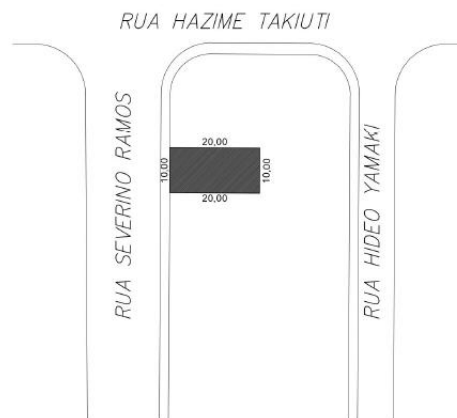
Localização de acordo com a planta do Loteamento.
